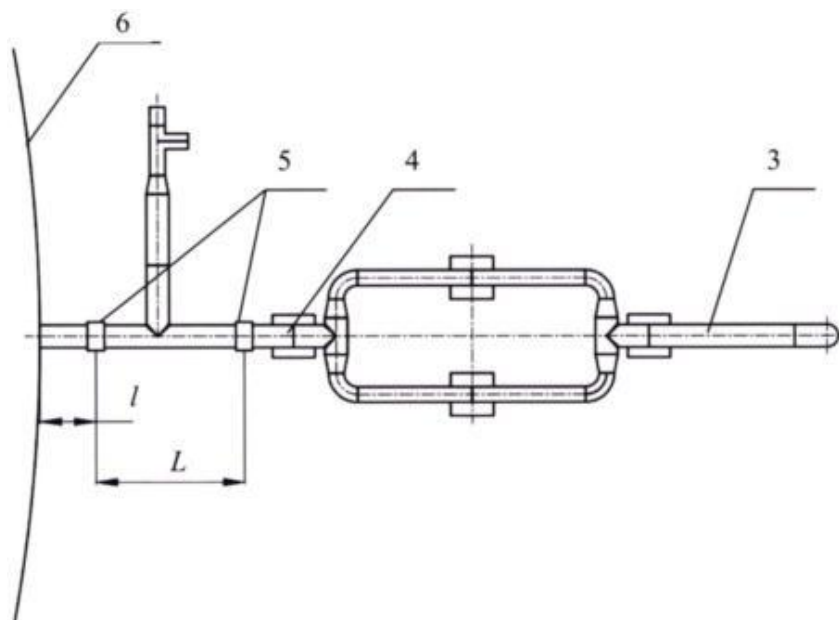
Схема установки гибких вставок на горизонтальный трубопровод подводки системы подслоного пожаротушения снаружи резервуара
